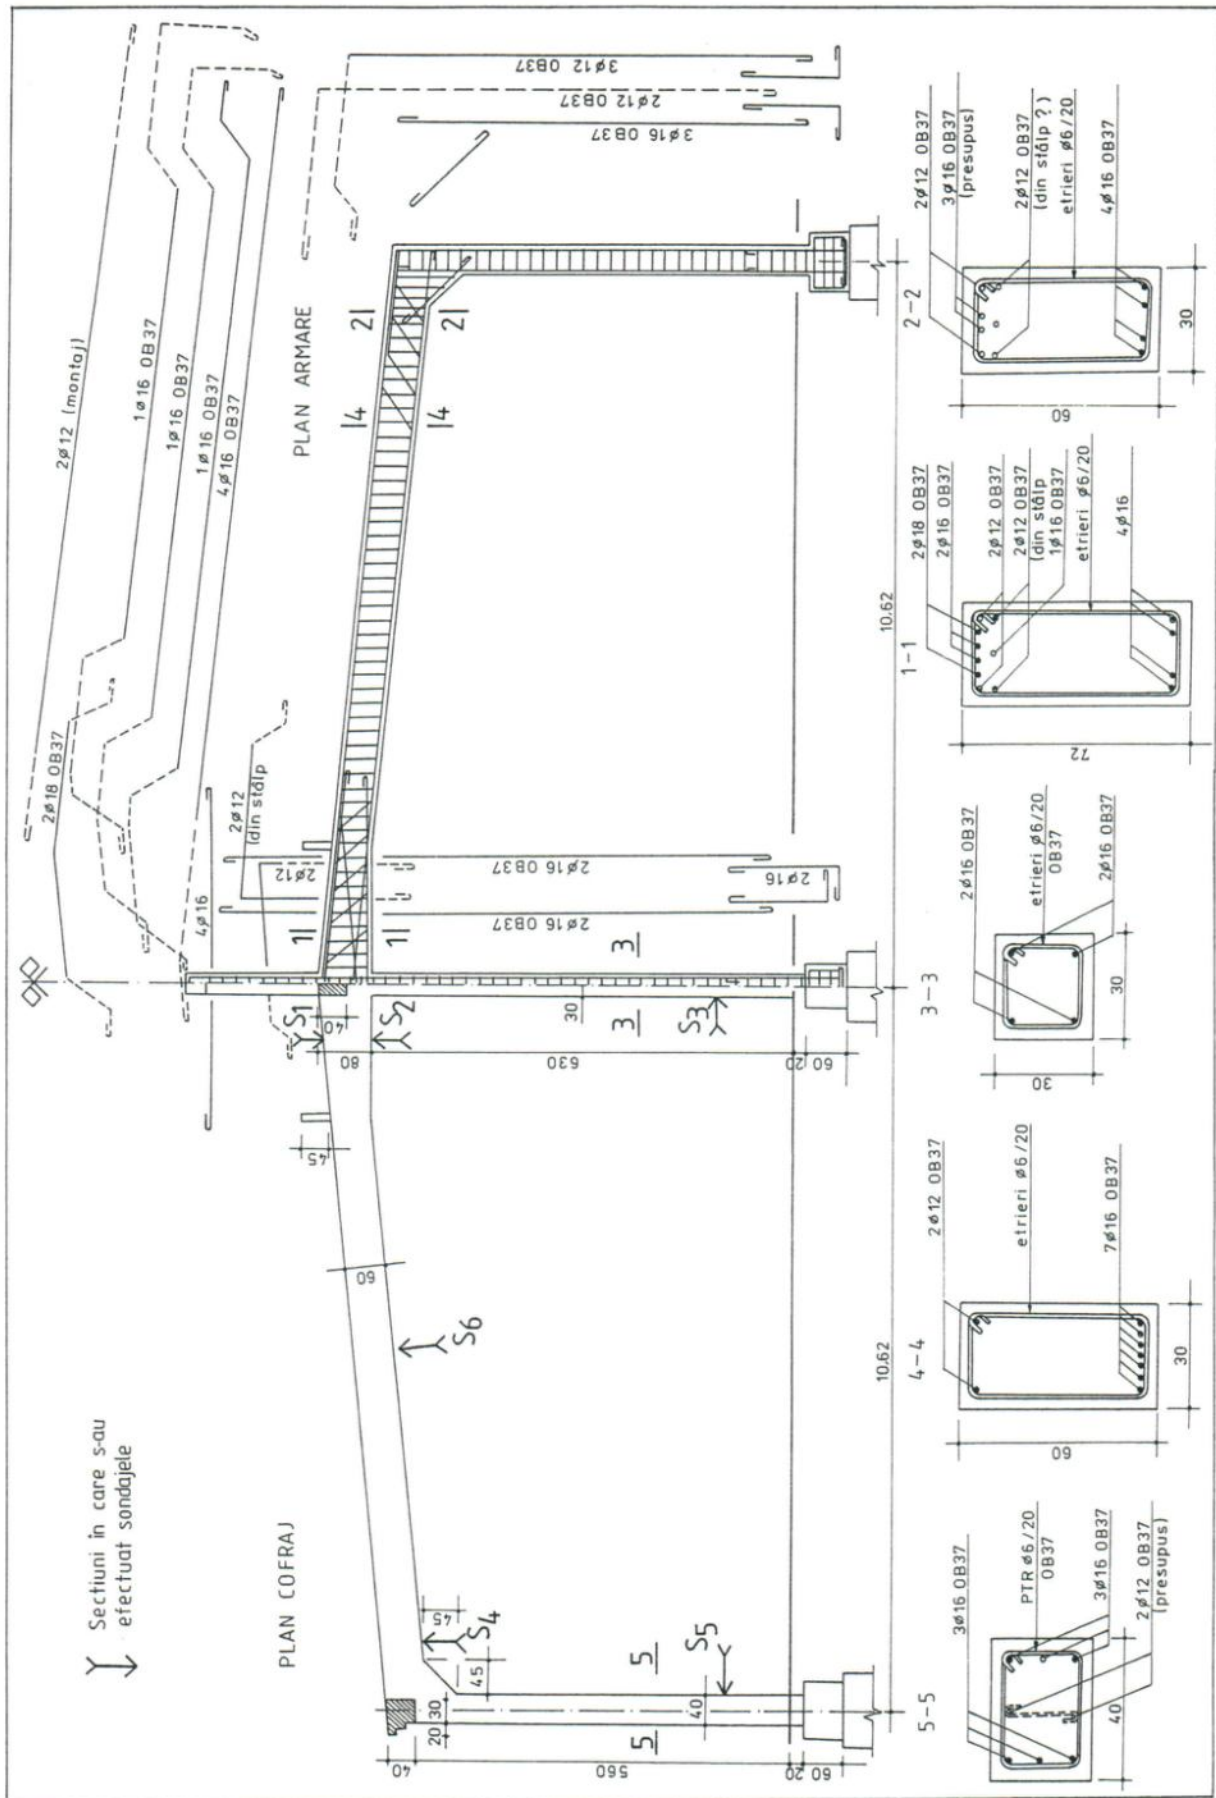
Relevul geometric și armarea unui cadru din beton armat determinată prin sondaje
